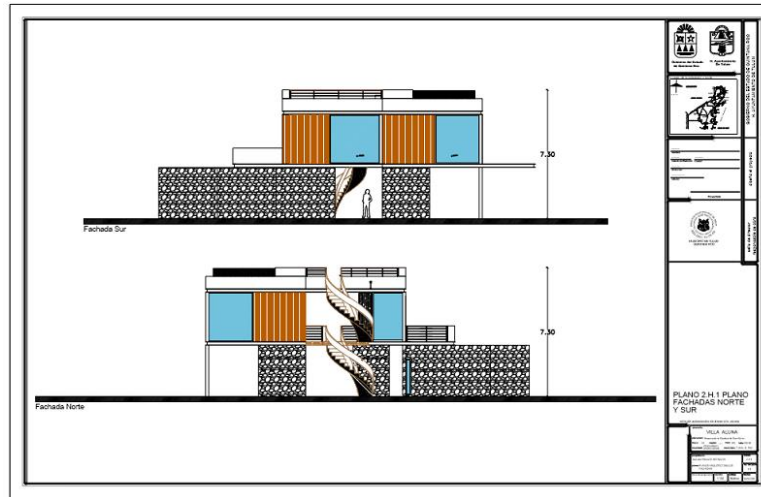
Fachadas Norte y Sur del proyecto "VILLA ALUNA".
